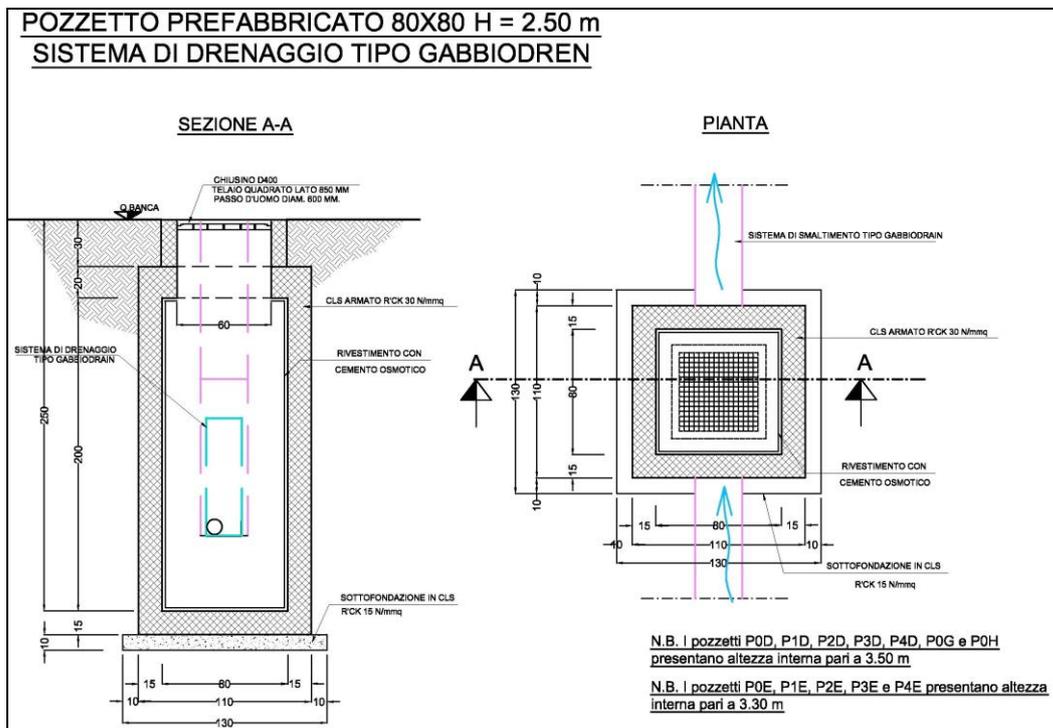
Pozzetto di ispezione sistema di drenaggio tipo Gabbiodren
